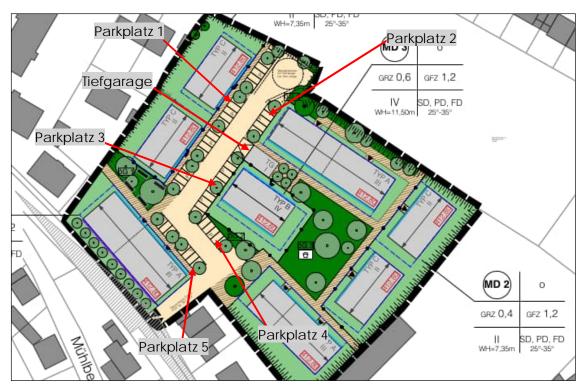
Übersichtslageplan mit Kennzeichnung der Parkflächen
